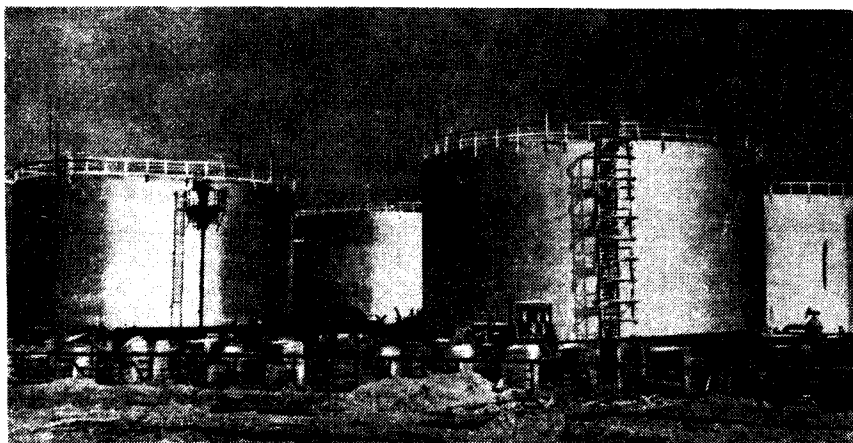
Загальний вигляд резервуарного парку нафтобази
